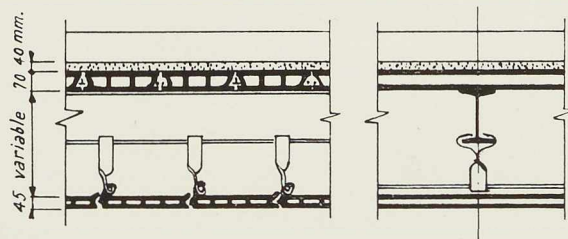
Coupe dans un plancher montrant le sous-plafond suspendu.
